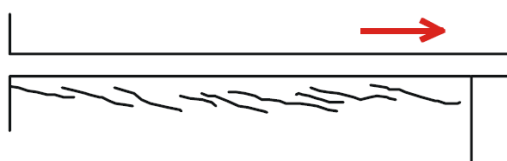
Fissura horizontal com componentes inclinados (escamas) por movimentação térmica da laje (VERÇOSA, 1991)
